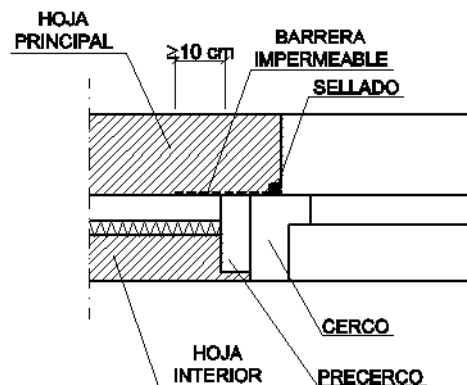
Ejemplo de encuentro de la fachada con la carpintería
